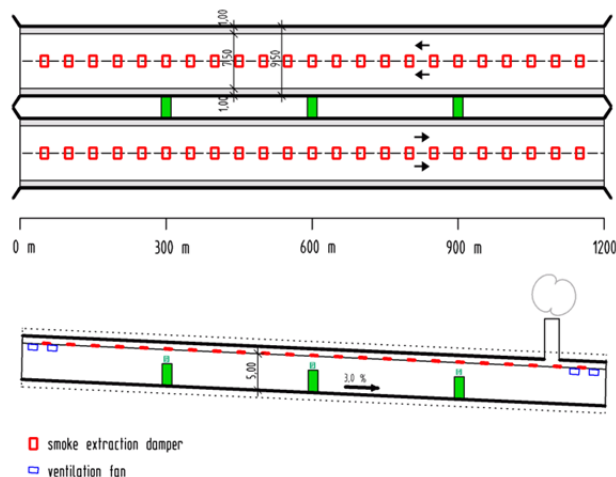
Grundriss und Längsschnitt des Modelltunnels
